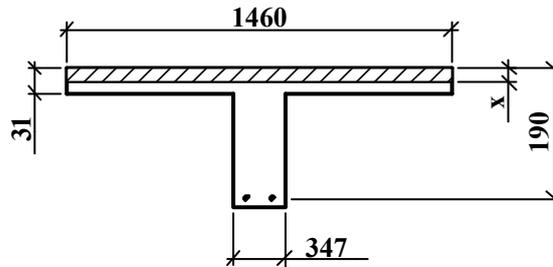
Поперечное сечение многпустотной плиты
